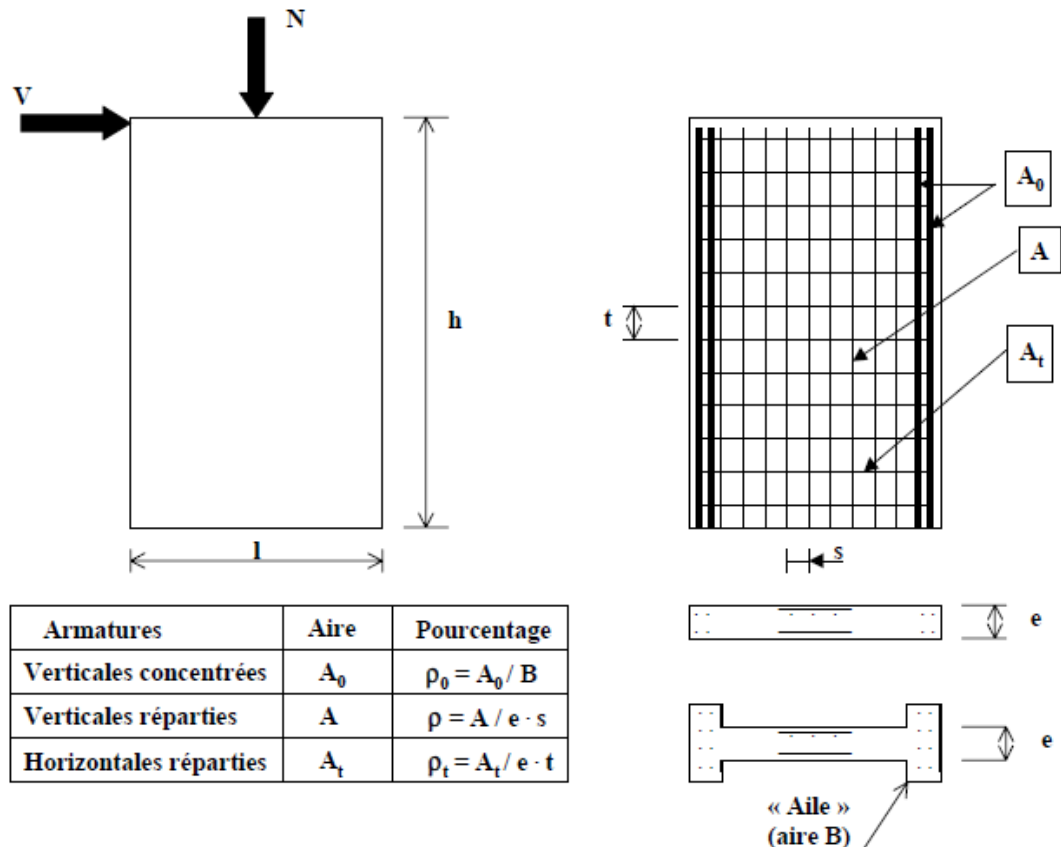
Schéma d'un voile plein et disposition du ferrailage. (12)
